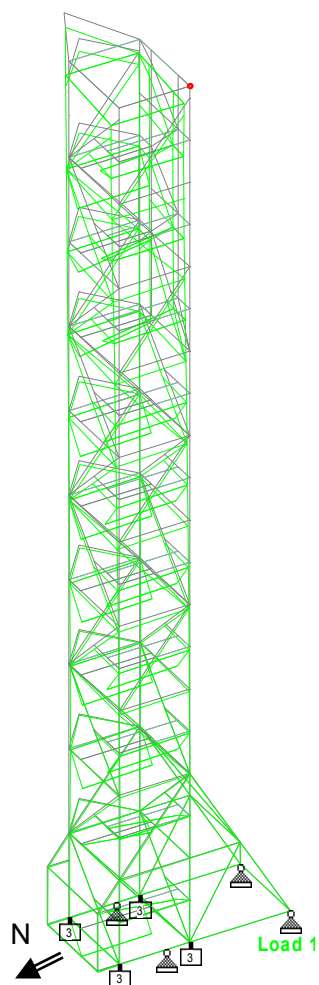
Reaksjonskrefter for Konstruksjon B
